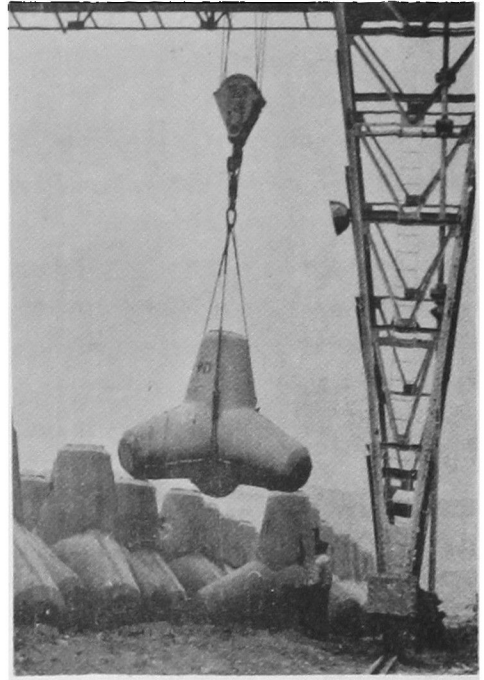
Traslado de tetrapodos dentro de la planta. (Arica).
